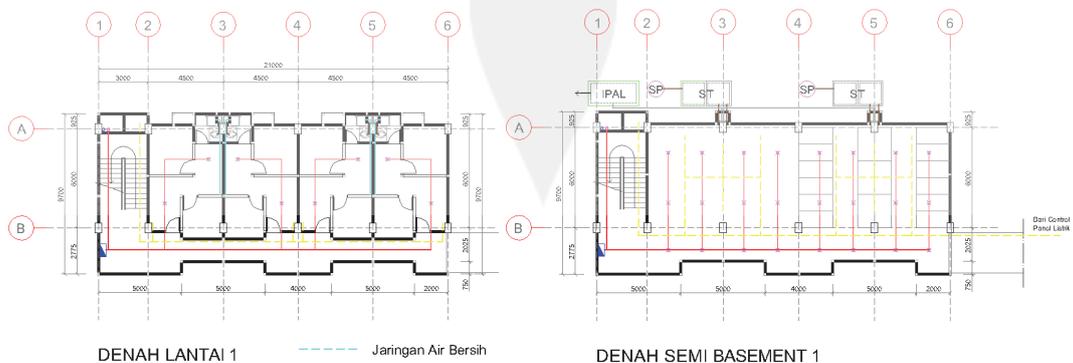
Utilitas Blok 1 Lantai Basement 1
